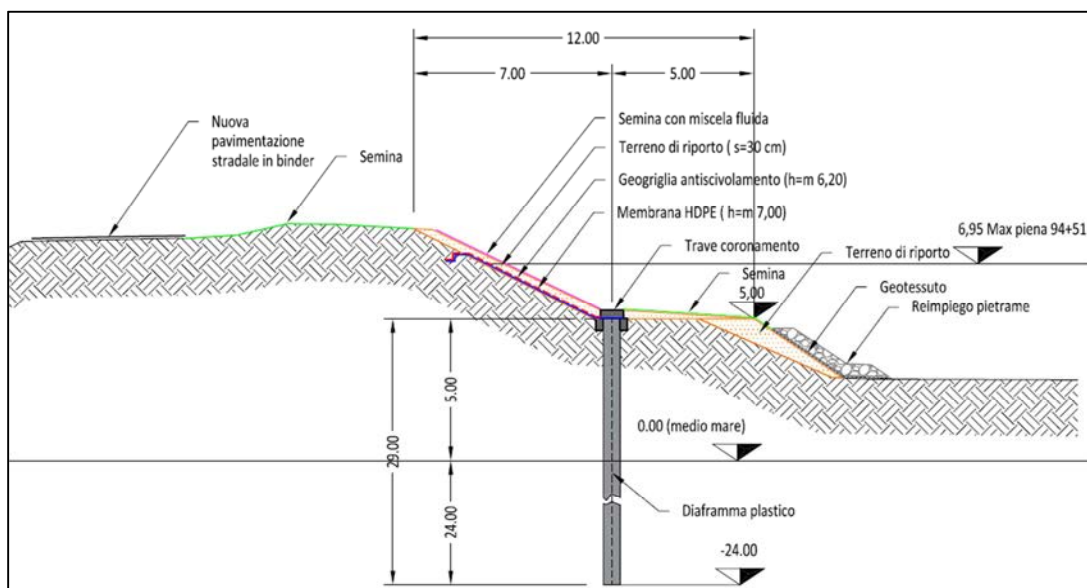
Località Cavanella Po - Sezione Tipo del diaframma (sviluppo 500 m)
